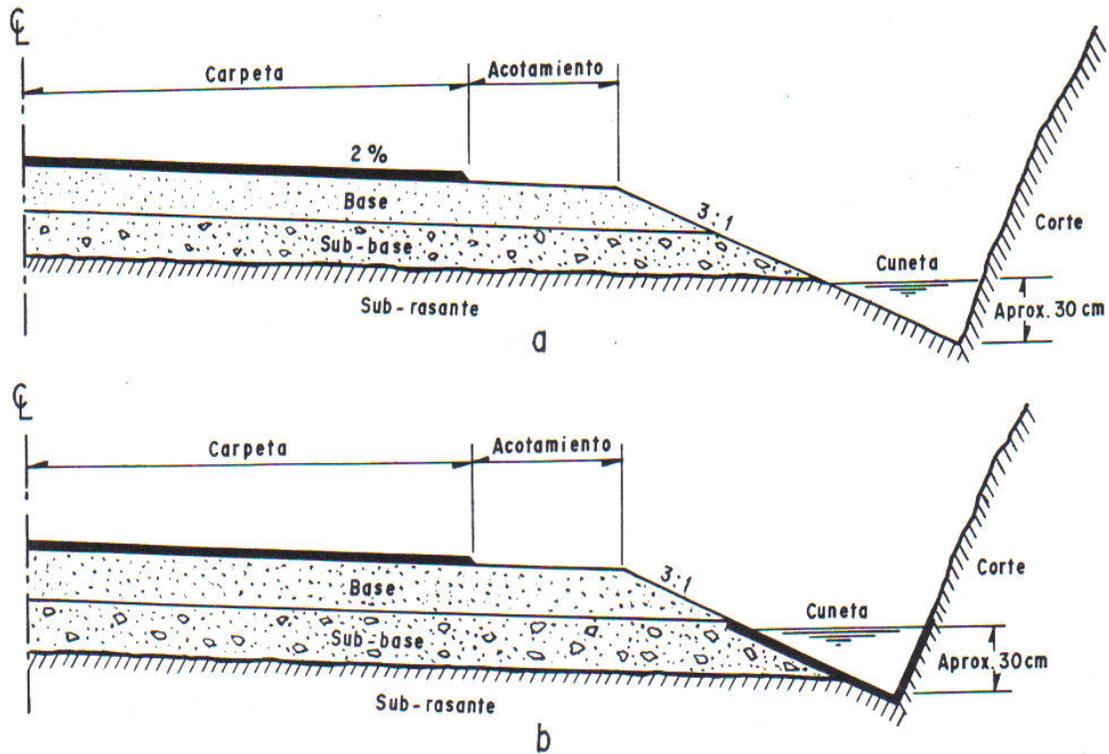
Disposición más conveniente de la cuneta, respecto al pavimento. Sección corte, sin subdrenaje.
